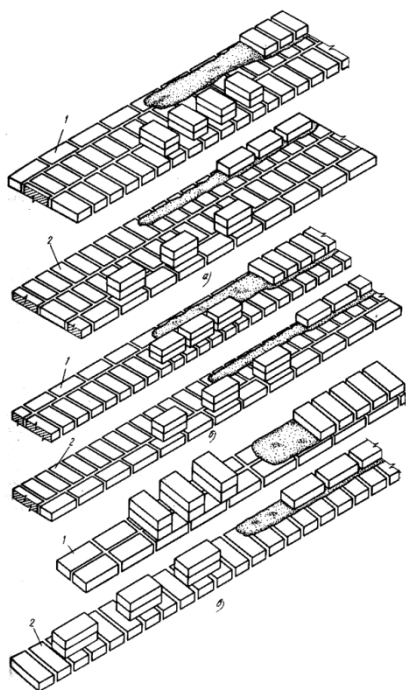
Раскладка кирпича при кладке стен толщиной:
